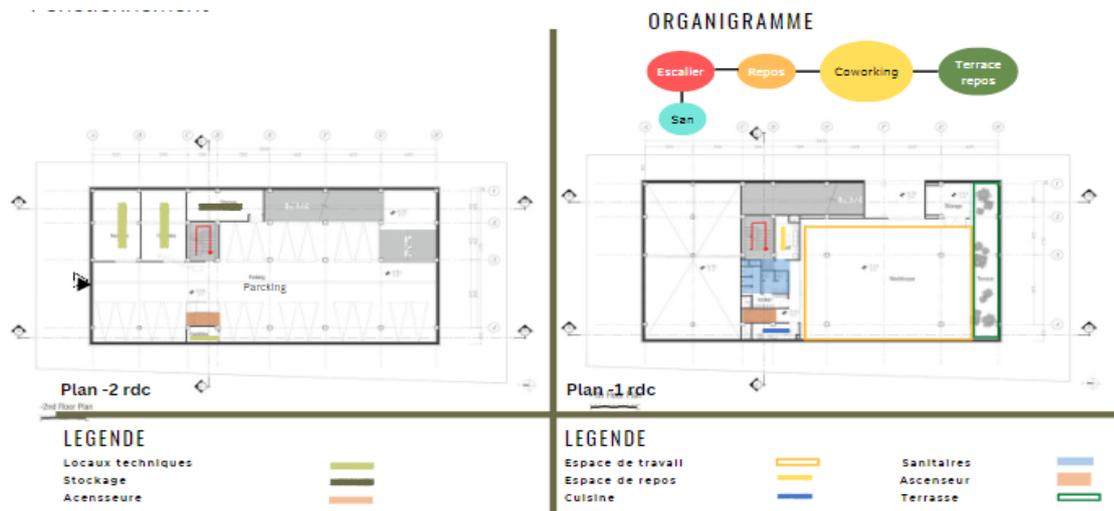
Plan soos-sol et entresol, Source: Archdaily galerie et auteur
